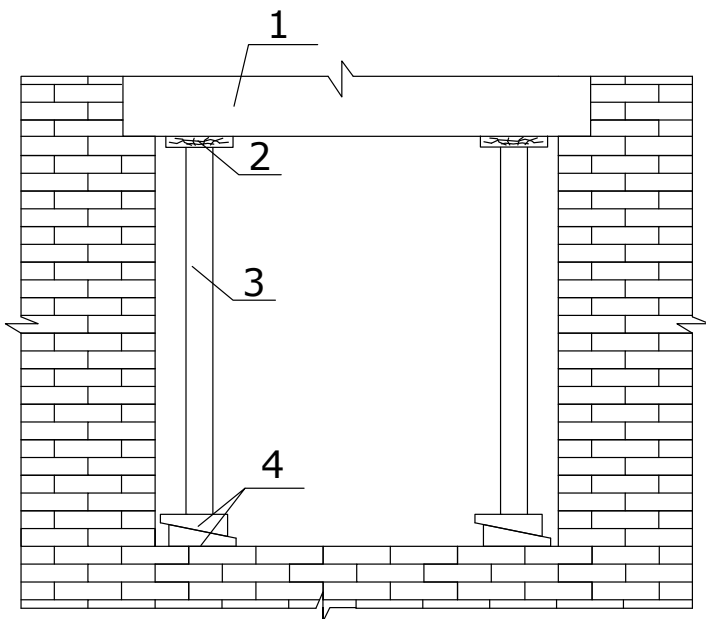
Схема разгрузки кирпичных простенков оконного проема:
